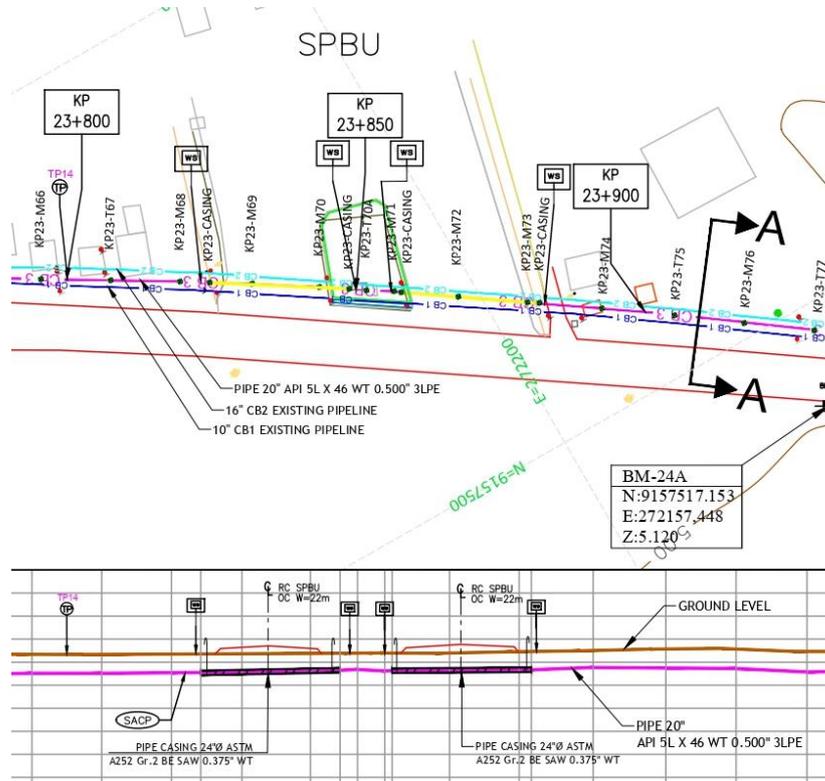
Pendetailan Crossing dalam Long Section (Sumber: Dokumen Perusahaan)
